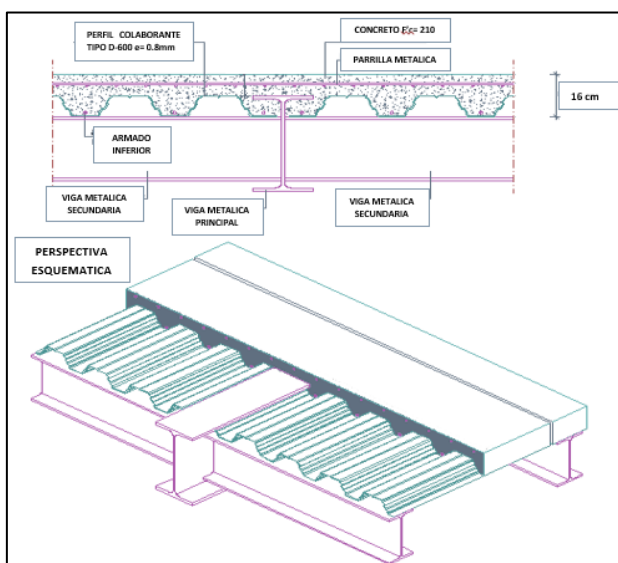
Sección constructiva de losa tipo deck enrasada con la viga metálica principal
